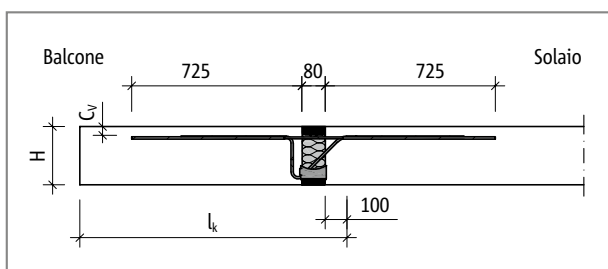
Schöck Isokorb® T tipo KL-M8 - M12: sistema statico
